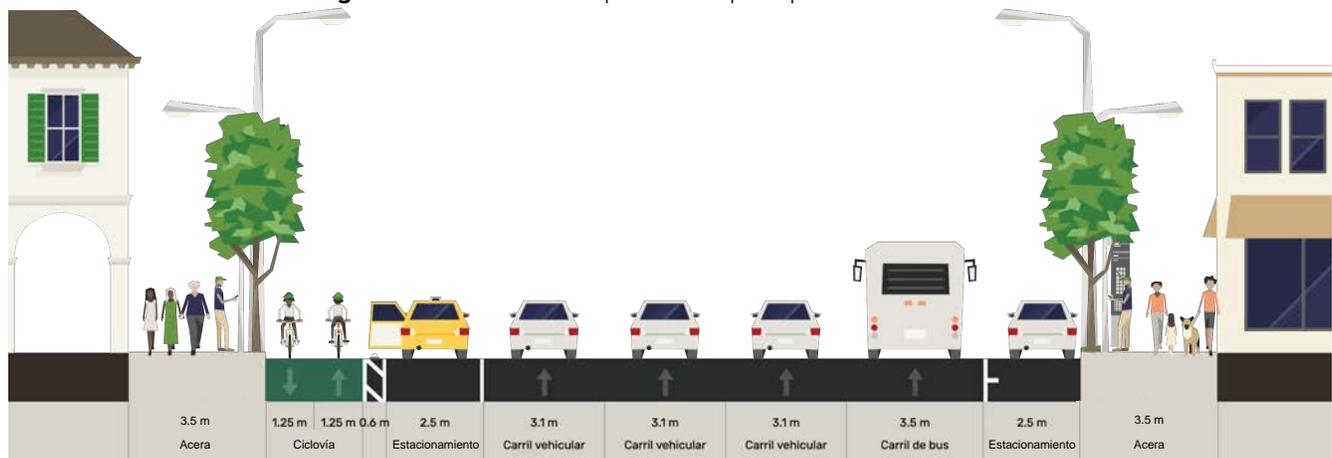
Detalle de sección vial tipo de la vía principal de doble sentido
